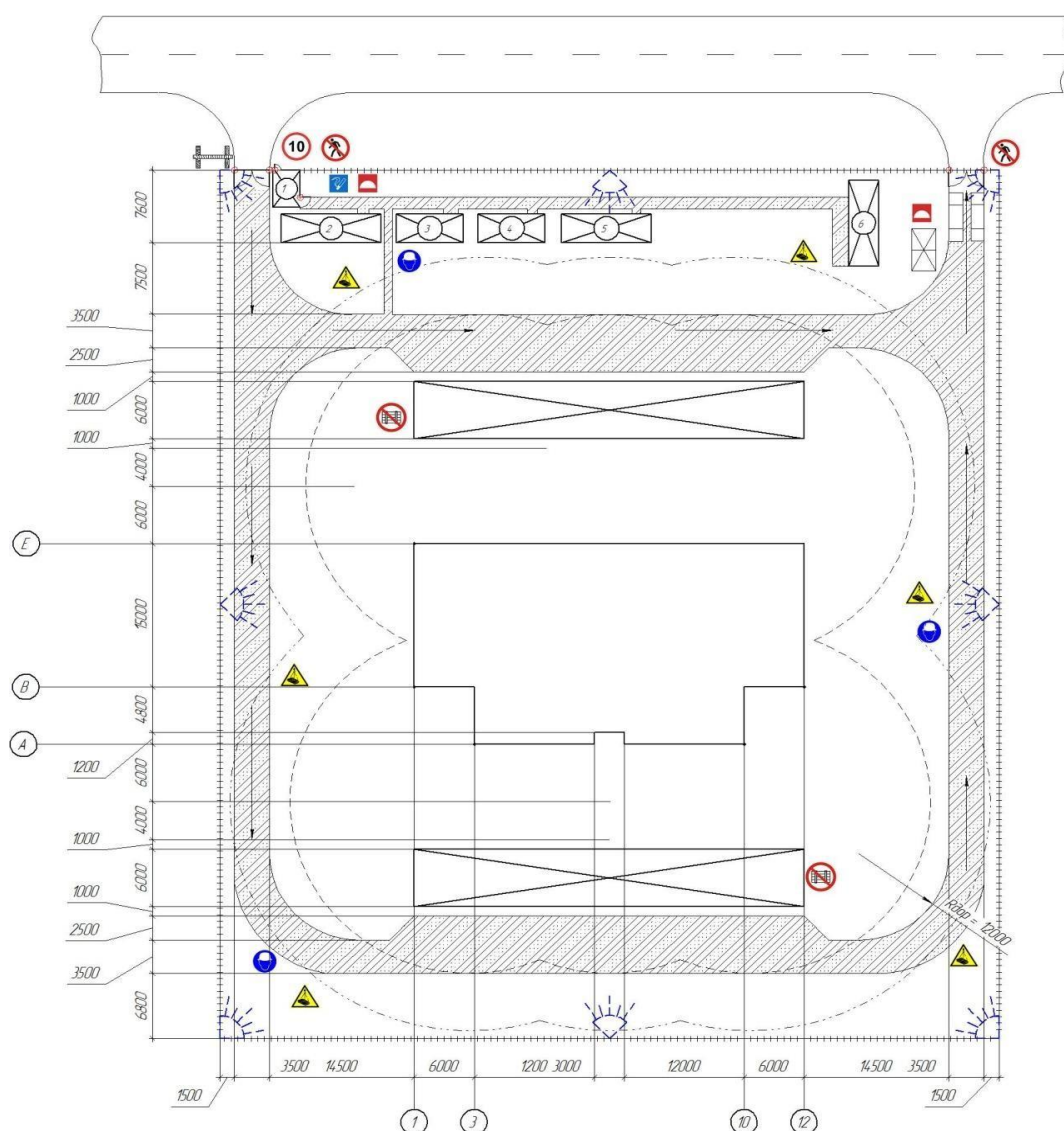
План строительной площадки ООО «Департамент ЖКУиС»
